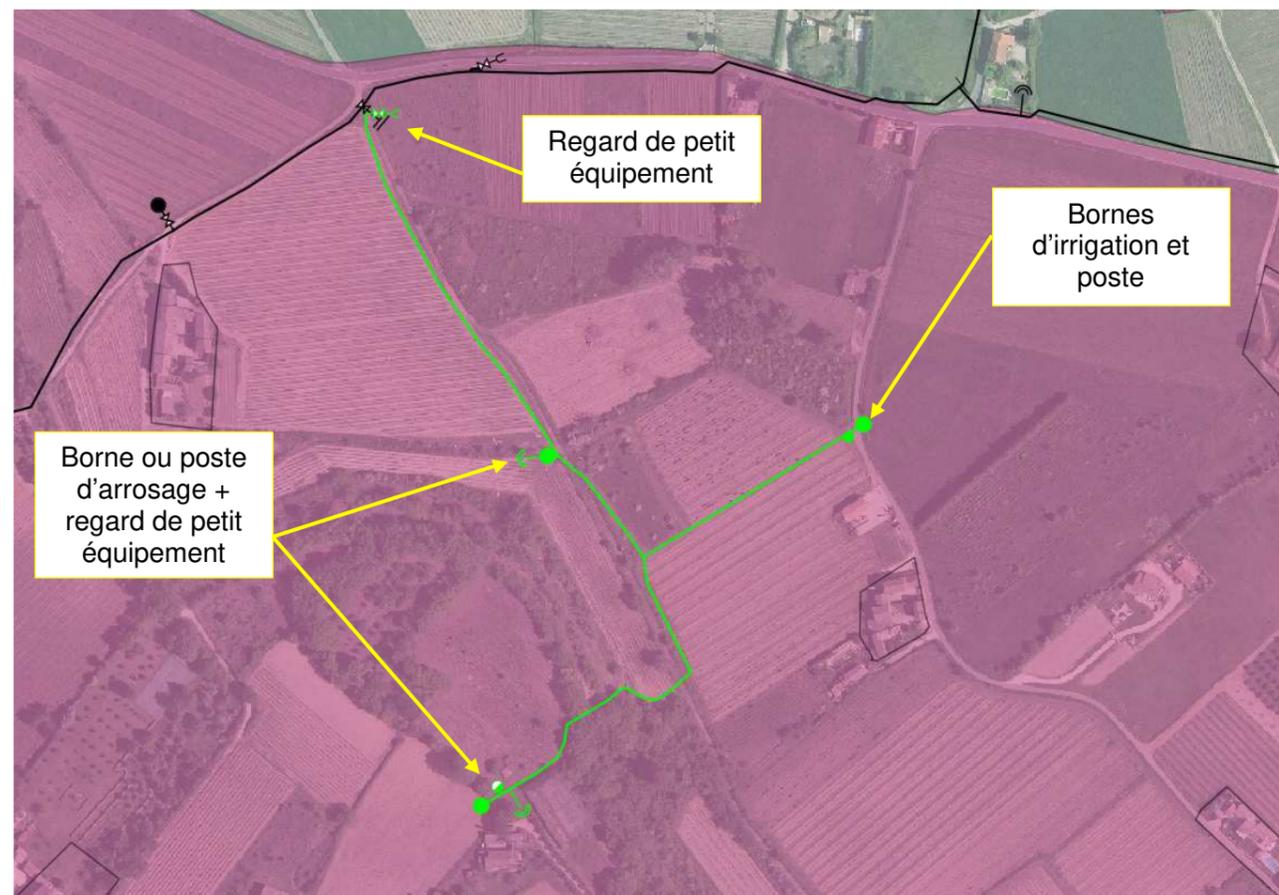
Zoom Secteur ouest (St Laurent) sur fond photo aérienne (source : Orthophoto) – En vert : projet / en noir : réseau et ouvrages existants
